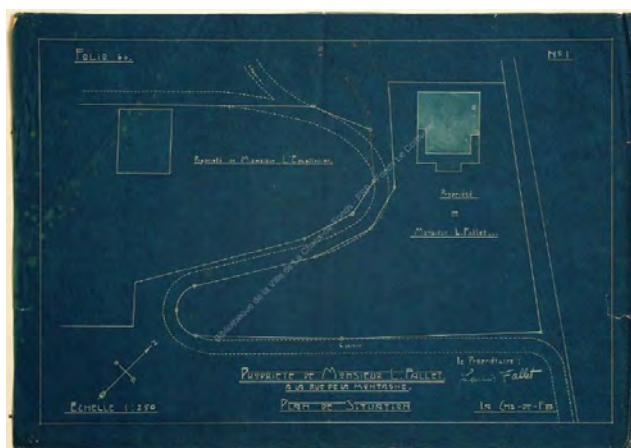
Situationsplan de Villa Fallet mit grosszügigem Umschwung. Von Louis Fallet signierter. Undatierter Plan.
